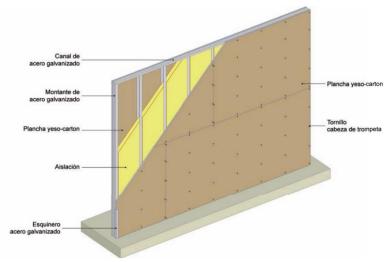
Ejemplo de la composición de un muro prefabricado. [2]
